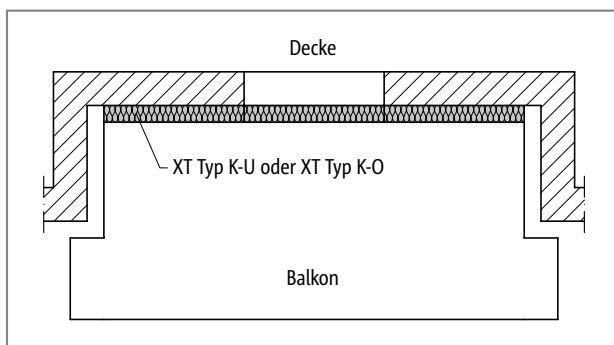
Schöck Isokorb® XT Typ K-U/K-O: Balkon bei Fassadenversprung
